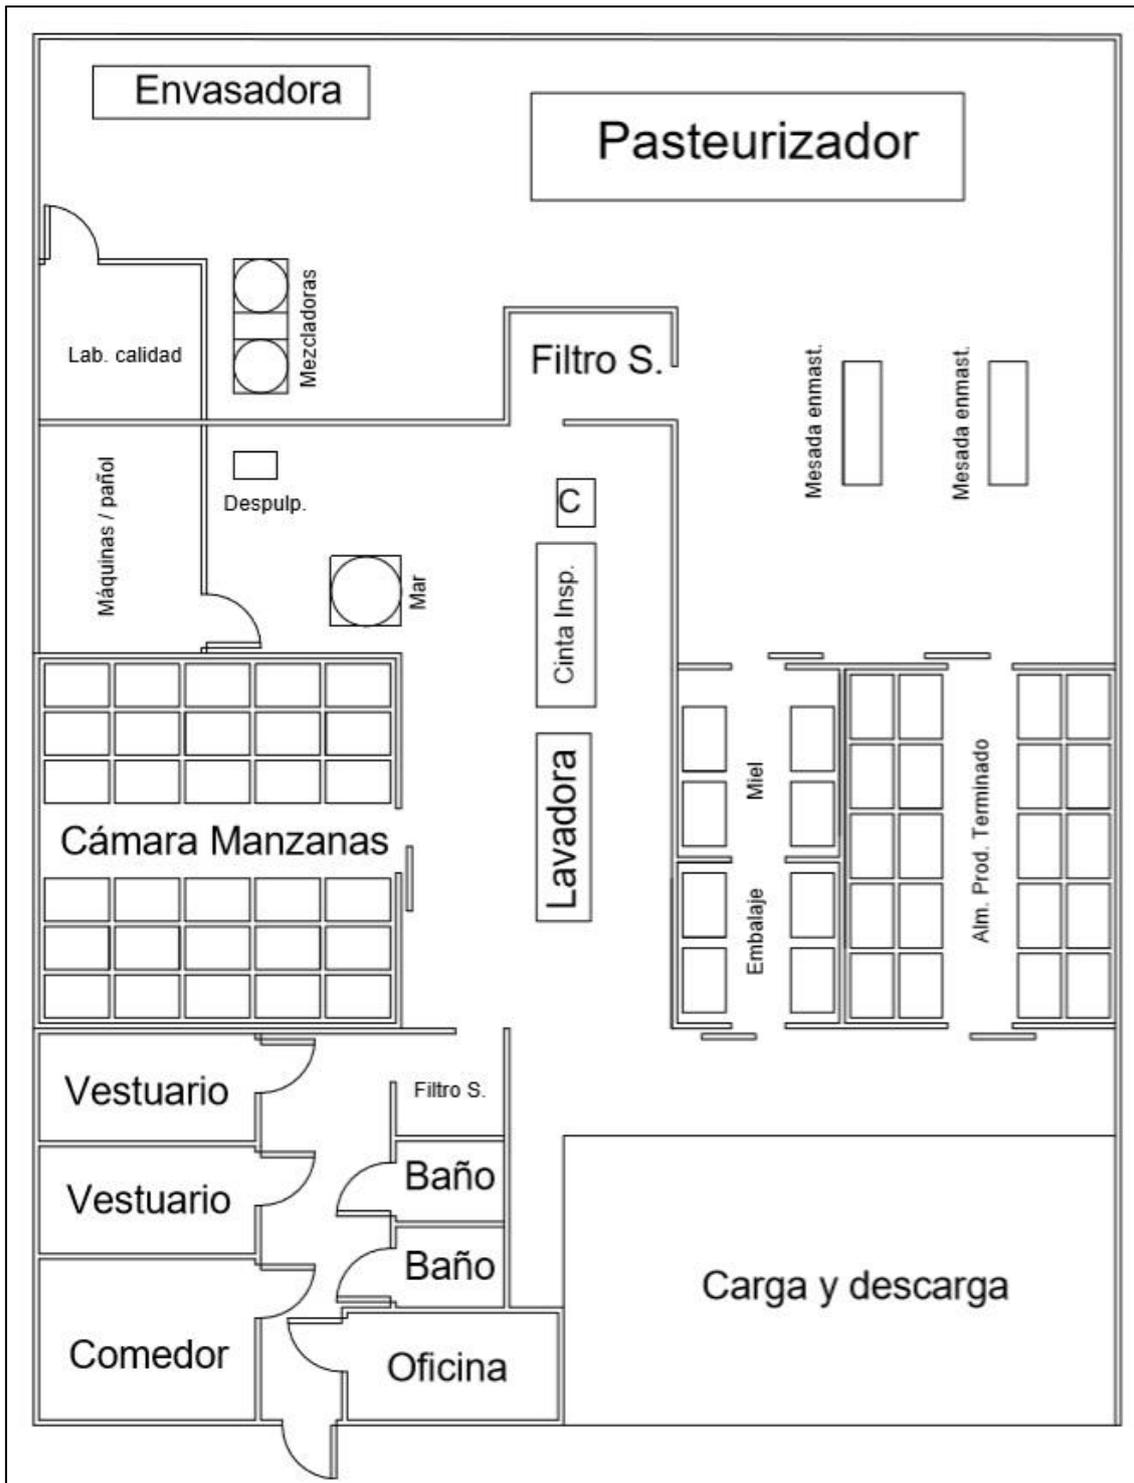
Layout planta elaboradora de puré de manzanas. (Elaboración propia)
